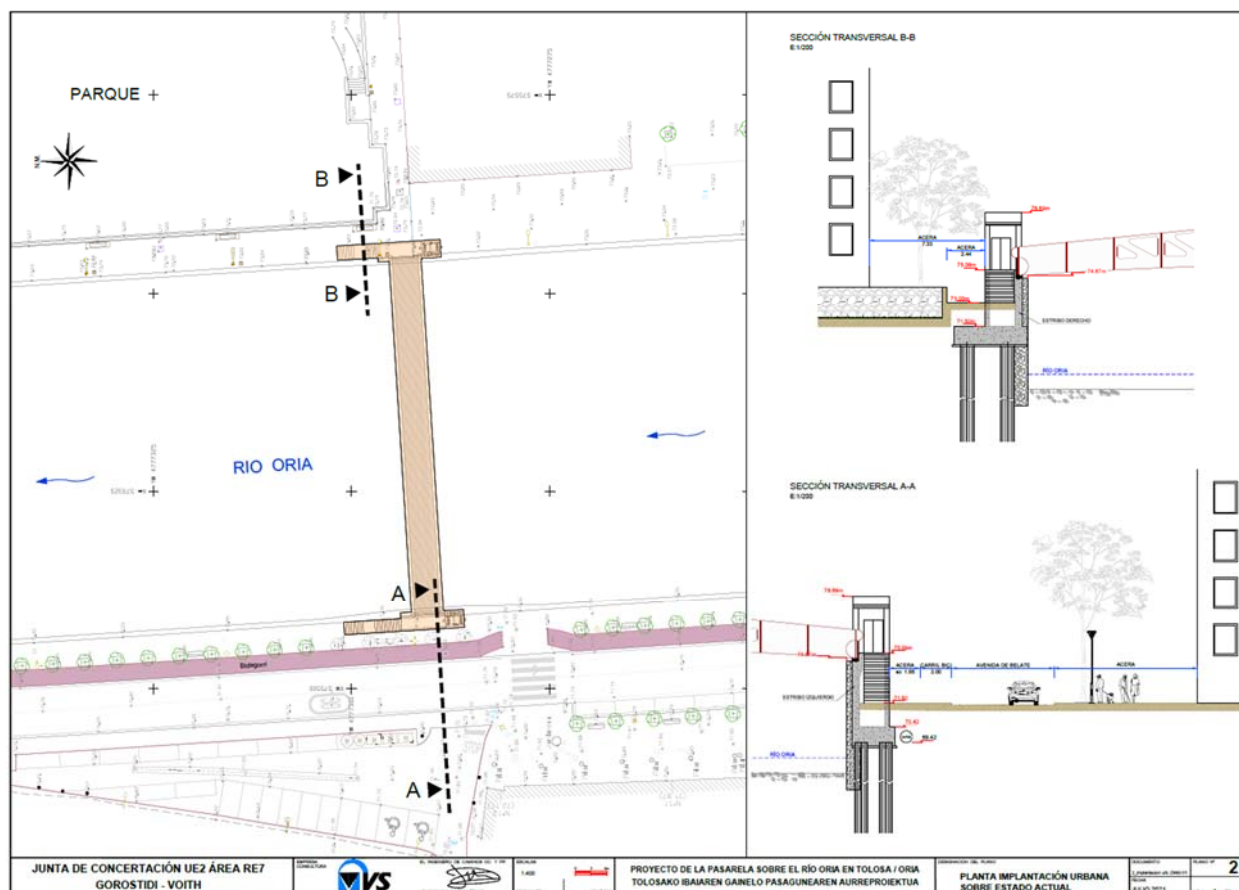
Imagen del plano nº 2 del proyecto, “Implantación urbana”.
